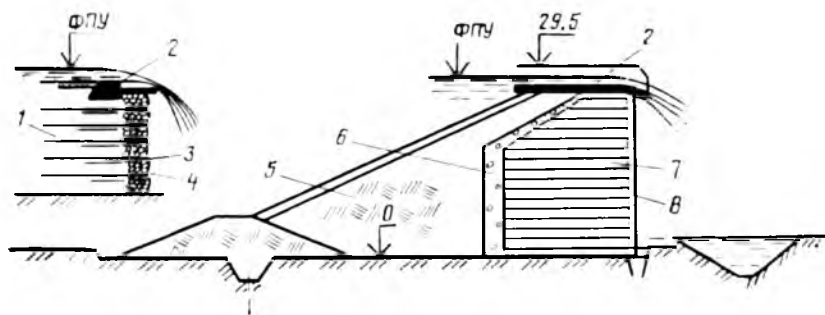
Схема армированной плотины Эстель (Франция):
